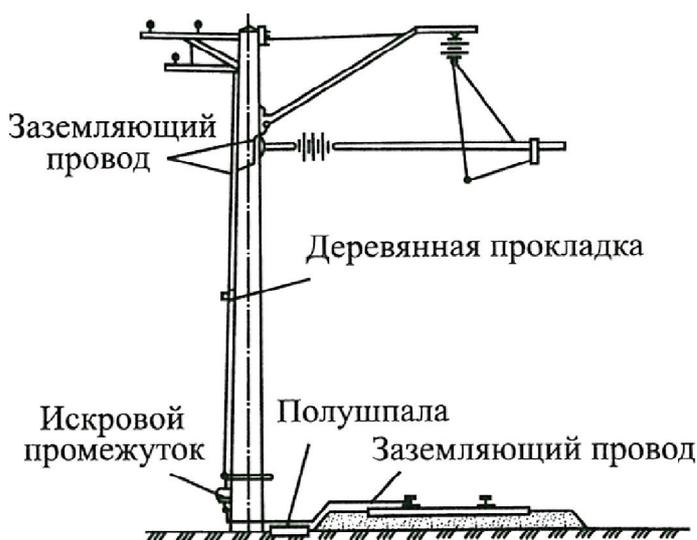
Схема установки заземлений на железобетонных опорах
